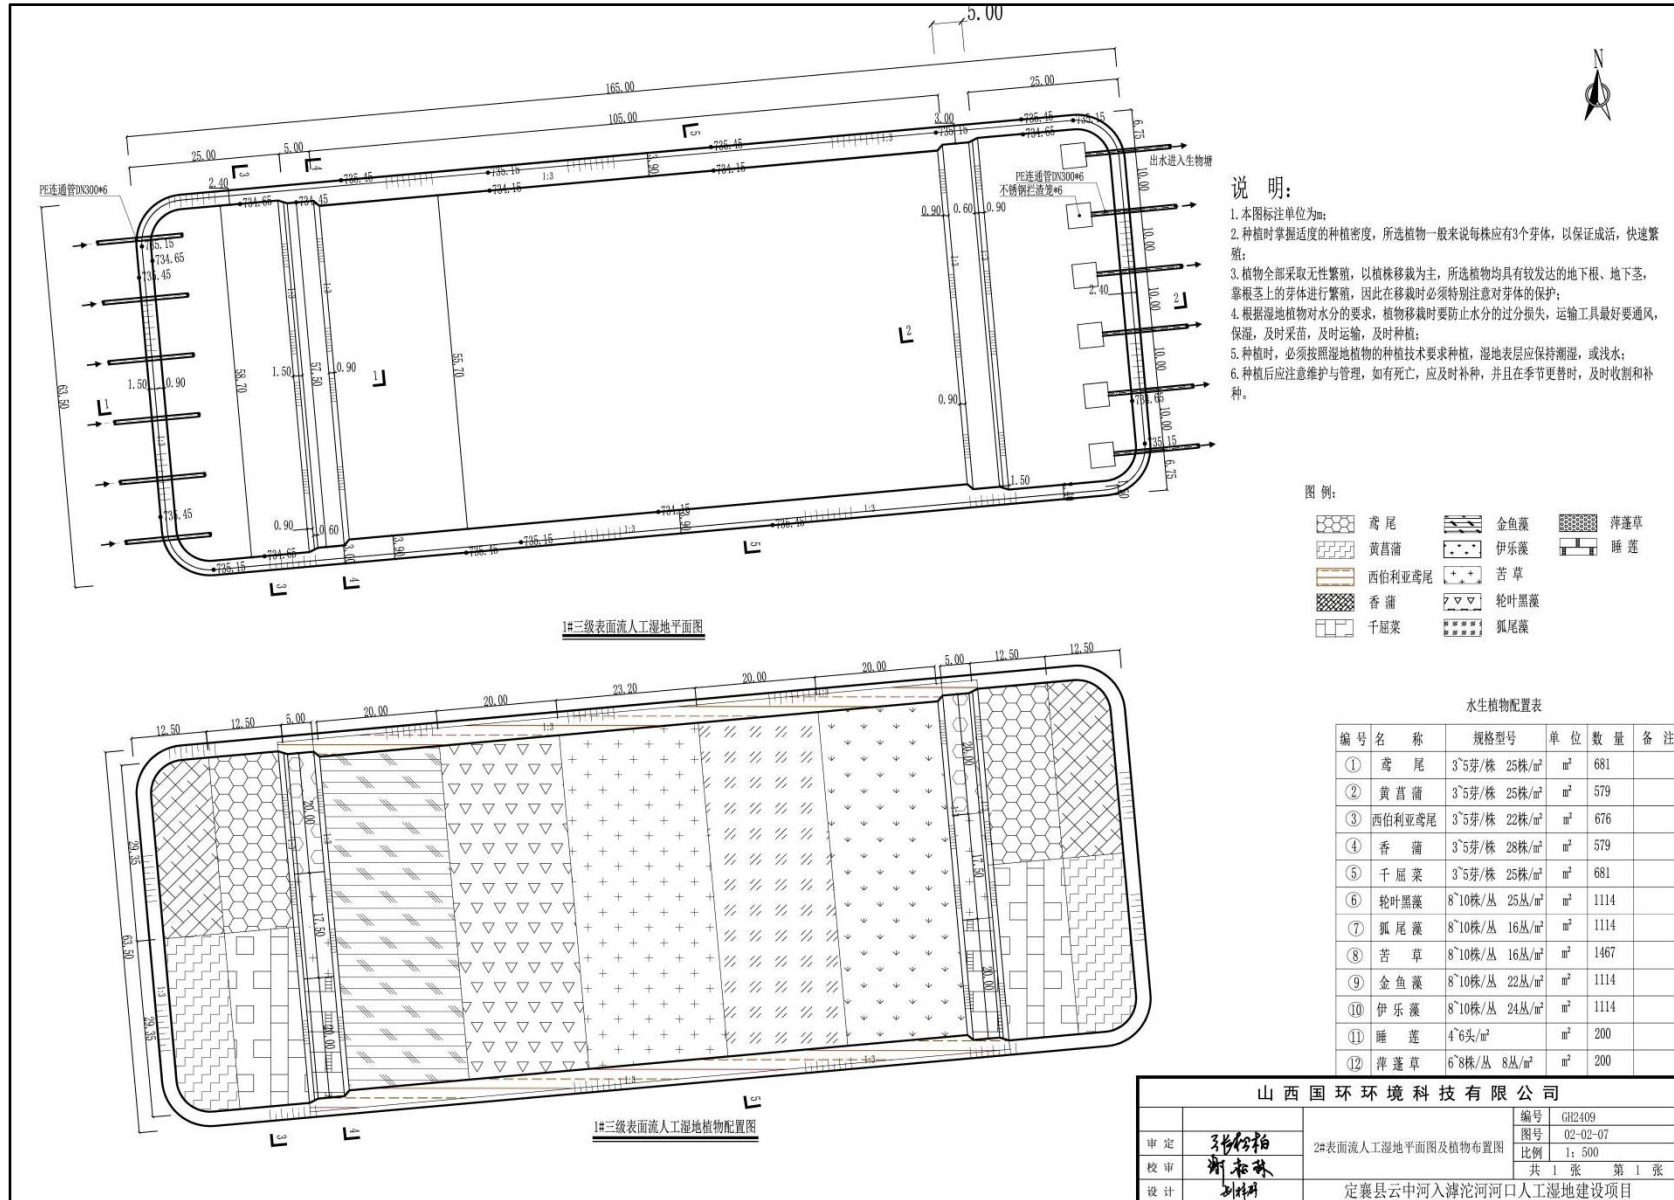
1#三级表面流人工湿地平面布置及植物配置图
